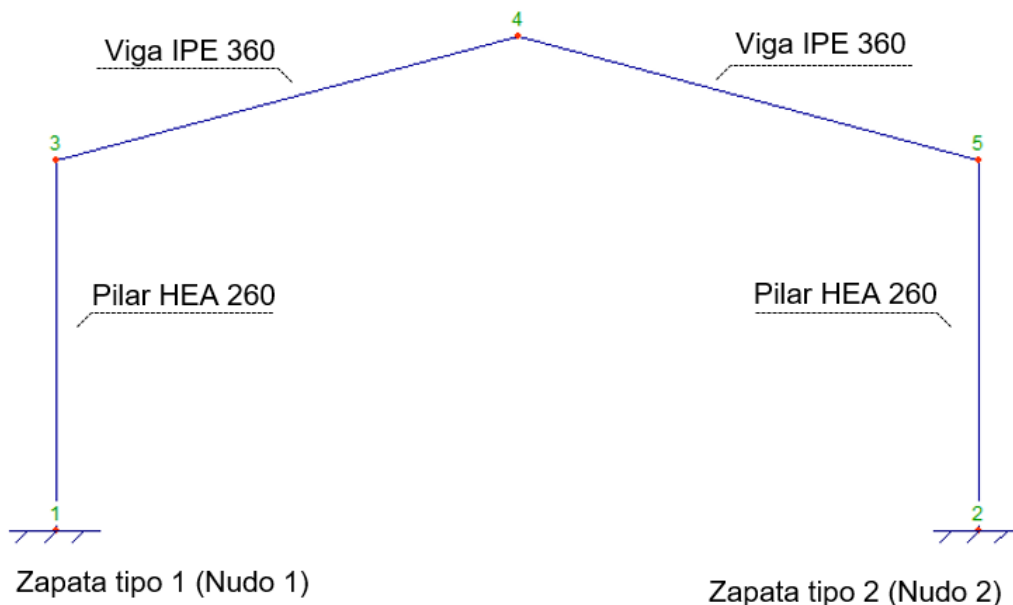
Detalle del tipo de zapata y del perfil de acero de cada elemento de la estructura metálica de los pórticos de la nave. Fuente: Metalpla XE 64
